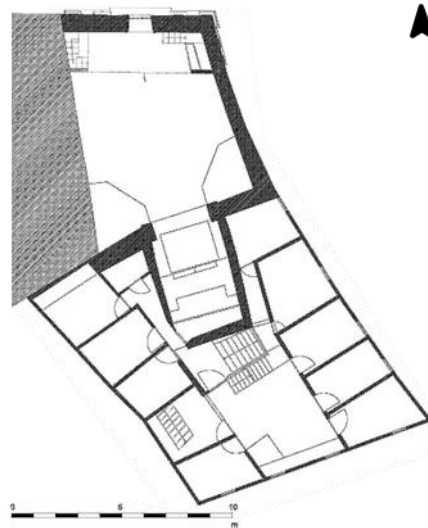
Planta do primeiro piso do Hospital-Albergaria dos Sapateiros (adaptado de <http://tinyurl.com/y8yq5zg5>)
